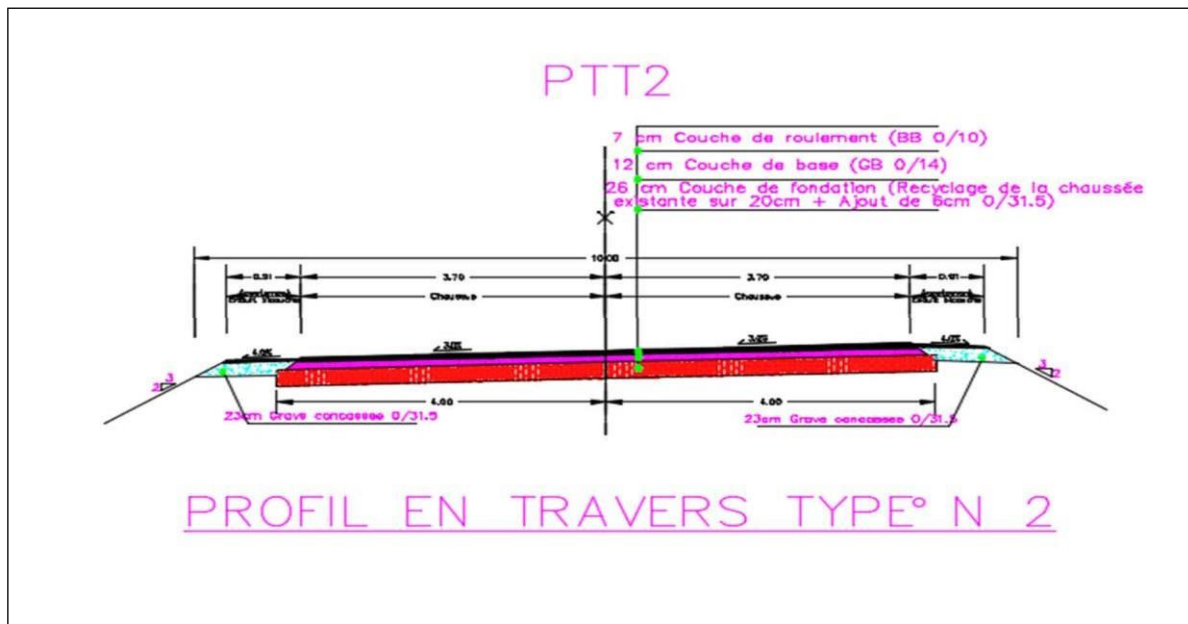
Profil en travers Type N :2(kmer, 2019)
